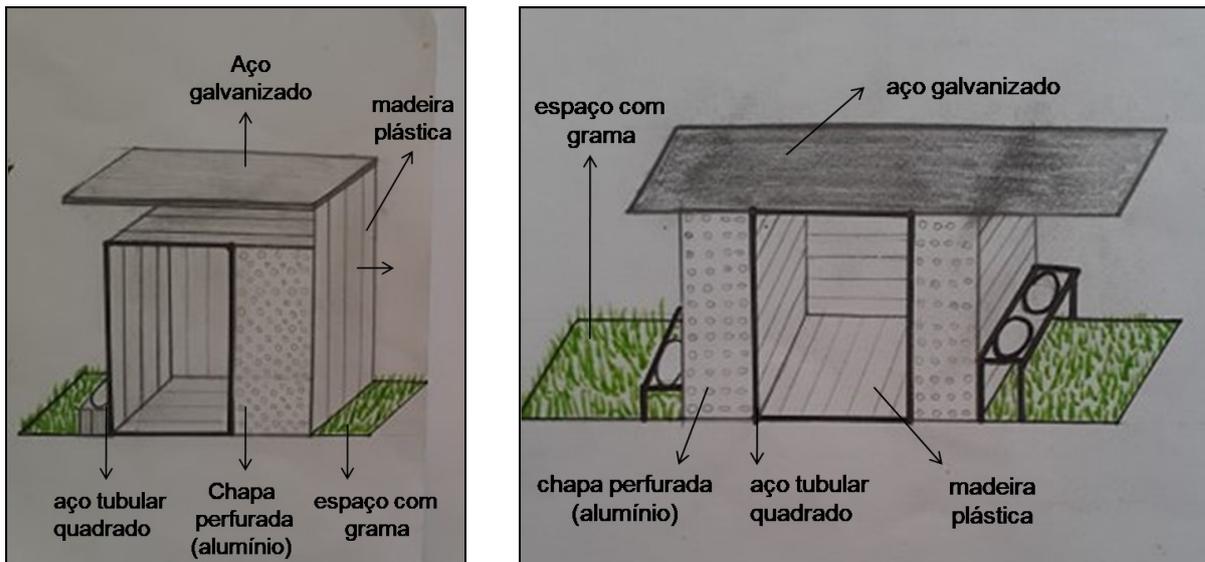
e 58 – Abrigos com estrutura em aço tubular quadrado.
